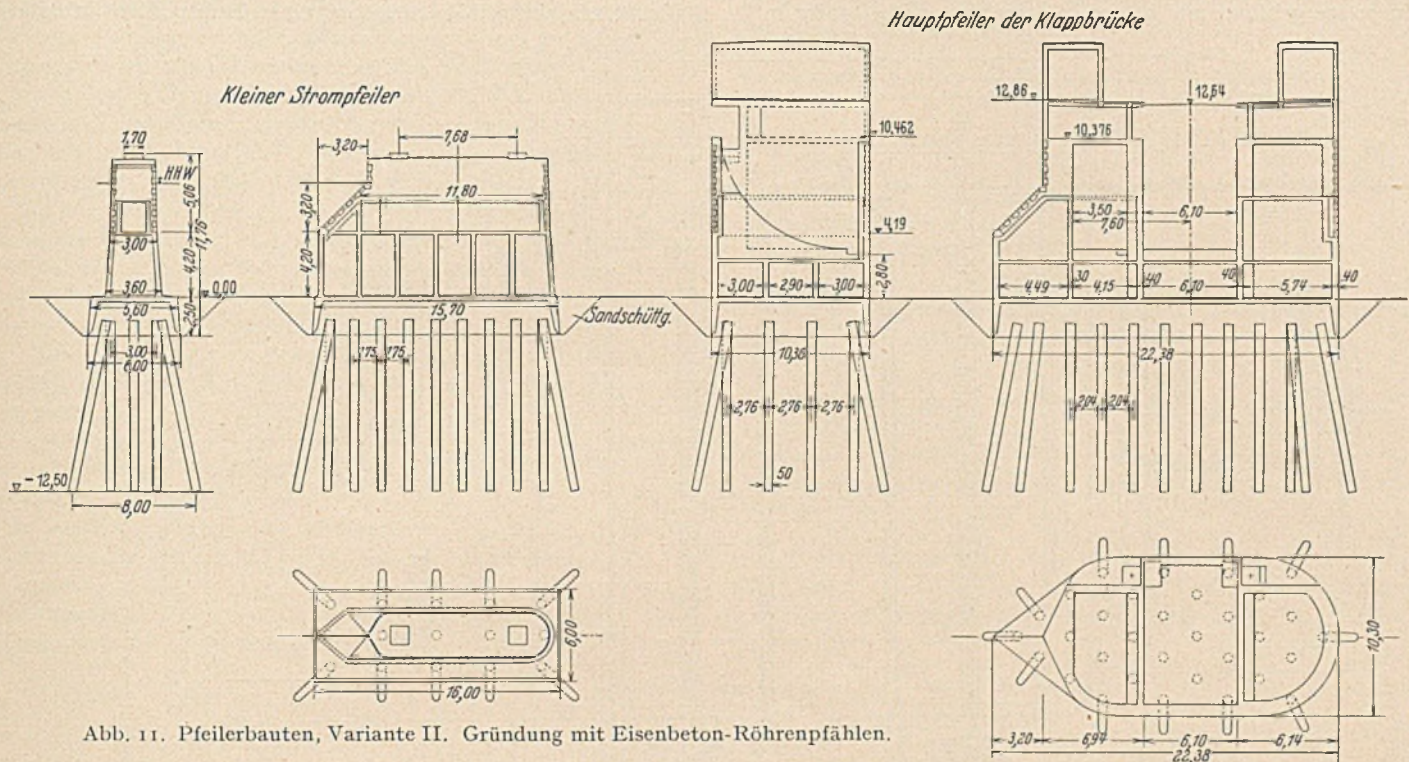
Pfeilerbauten, Variante II. Gründung mit Eisenbeton-Röhrenpfählen.
